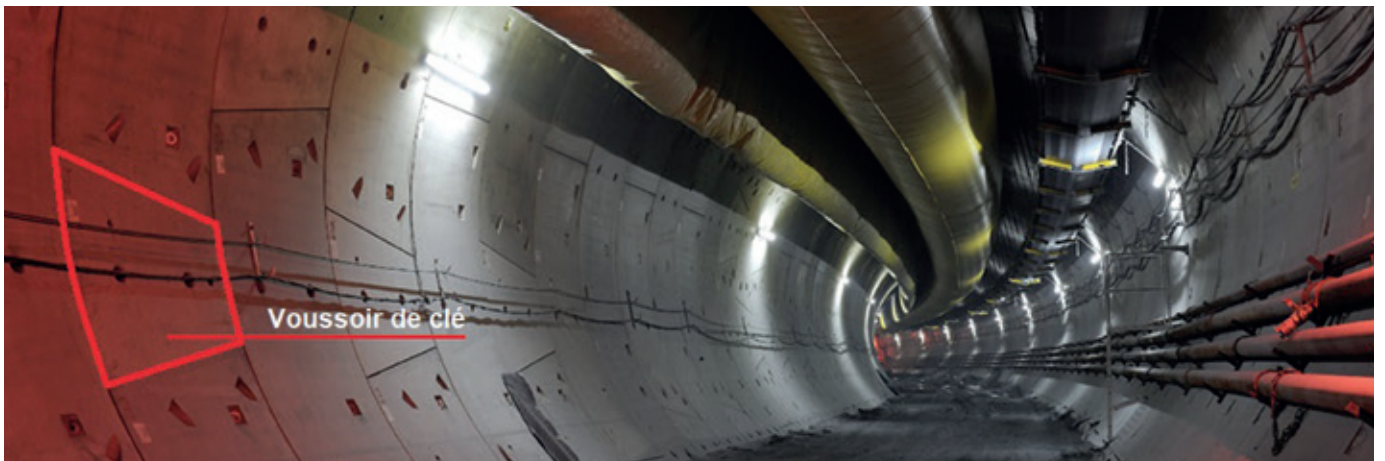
Revêtement en béton armé (voussoirs préfabriqués) [tunnel foré au tunnelier]
